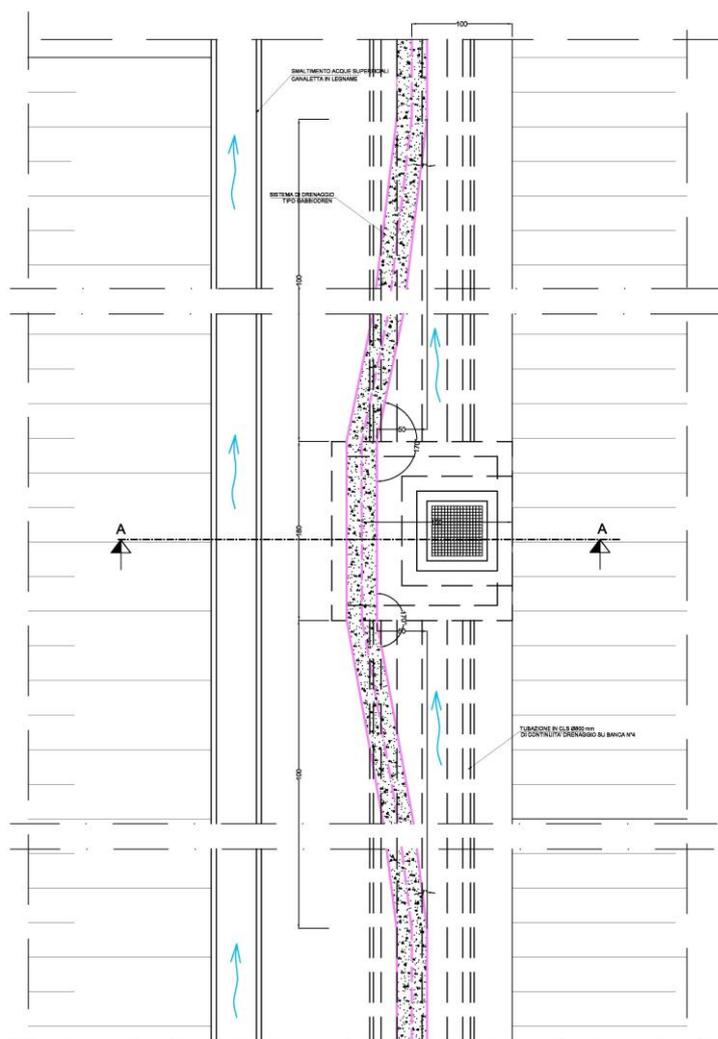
Deviazione trincea drenante tipo Gabbiodren in corrispondenza dei pozzetti di ispezione lungo la banca 4
